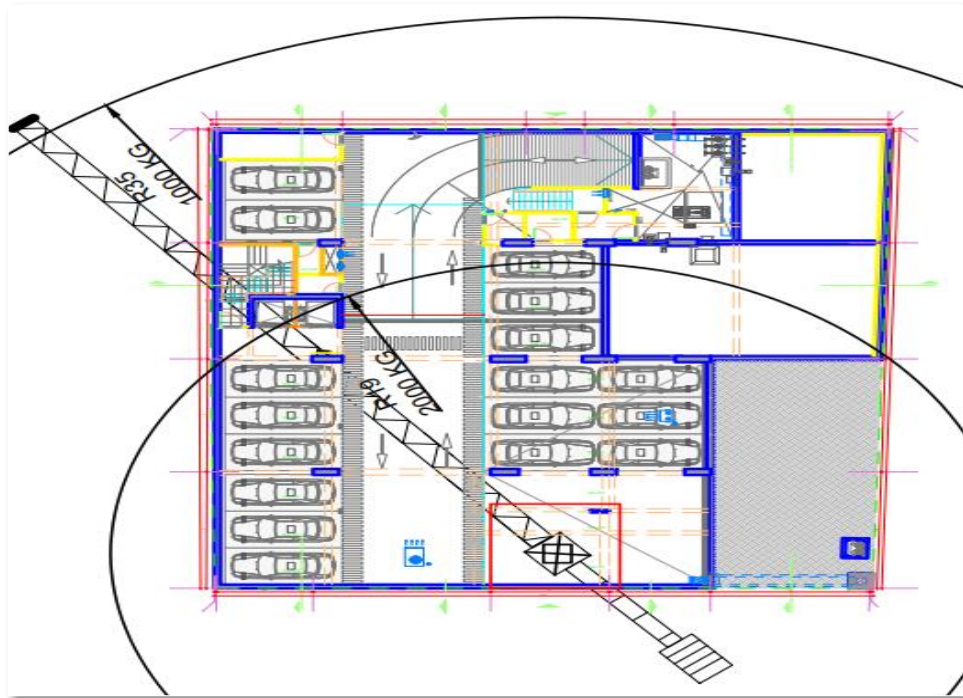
Longitud de pluma (Fuente: Elaboración propia)
